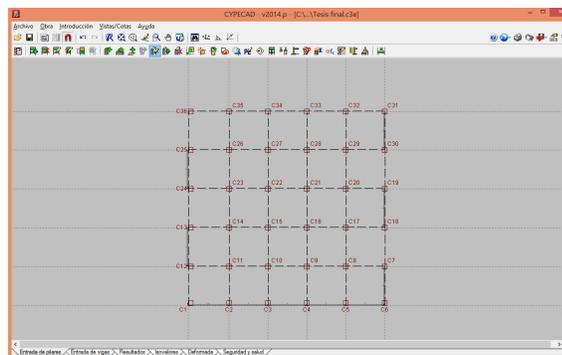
Ventana principal con la introducción de las columnas del proyecto
